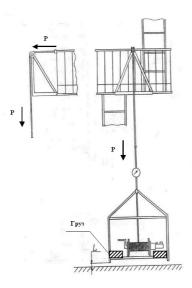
Испытание напрочность ограждения площадки лестницы (высота отрыва площадки от земли L=100-200мм)
